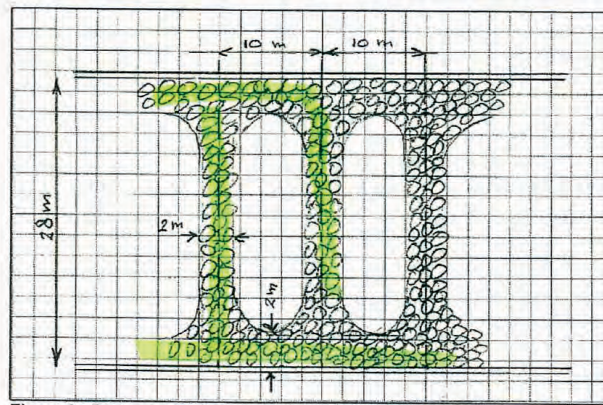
Grundriss Prinzipskizze horizontalen temporären Aussteifung unterhalb der Baugrubensohle
